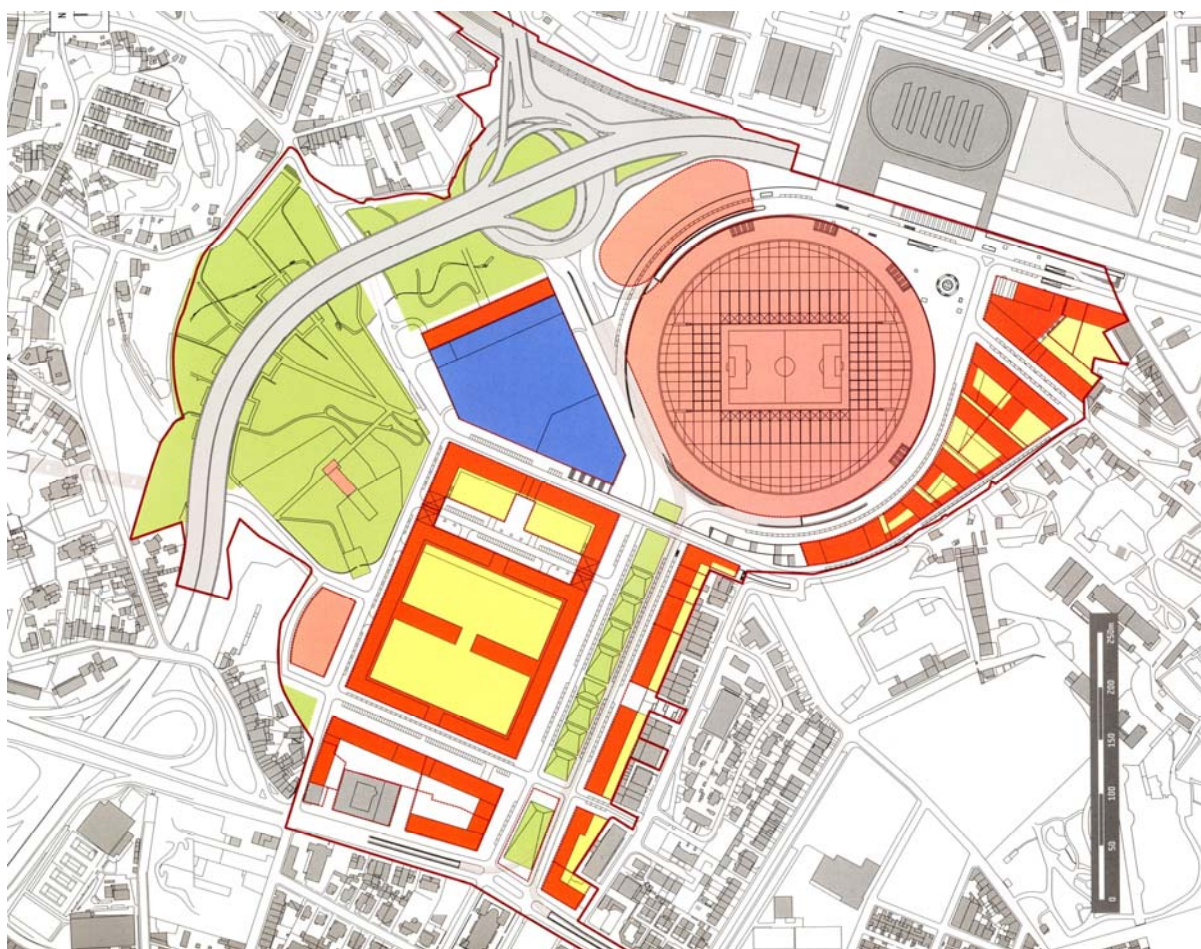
Planta de Implantação – Risco, arq.tºs
